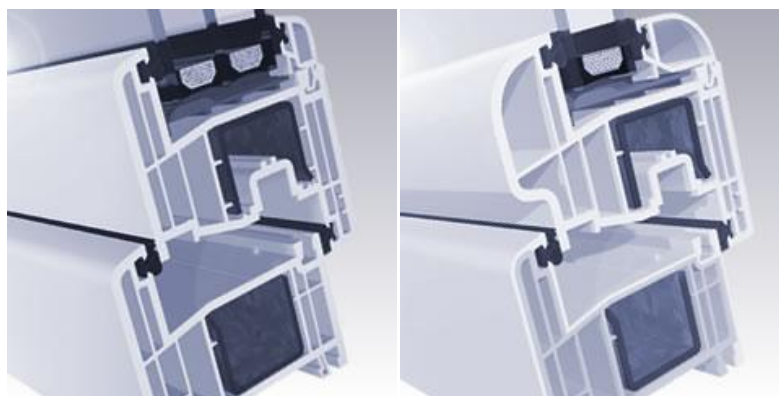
Profilsystem S 8000 IQ mit 6 Kammern; links: Dreifach-Wärmeschutzverglasung und flächenversetzte Ausführung mit zweifach abgeschrägter Glasleiste; rechts: Zweifach-Wärmeschutzverglasung und halbflächenversetzte Ausführung mit runder Glasleiste
